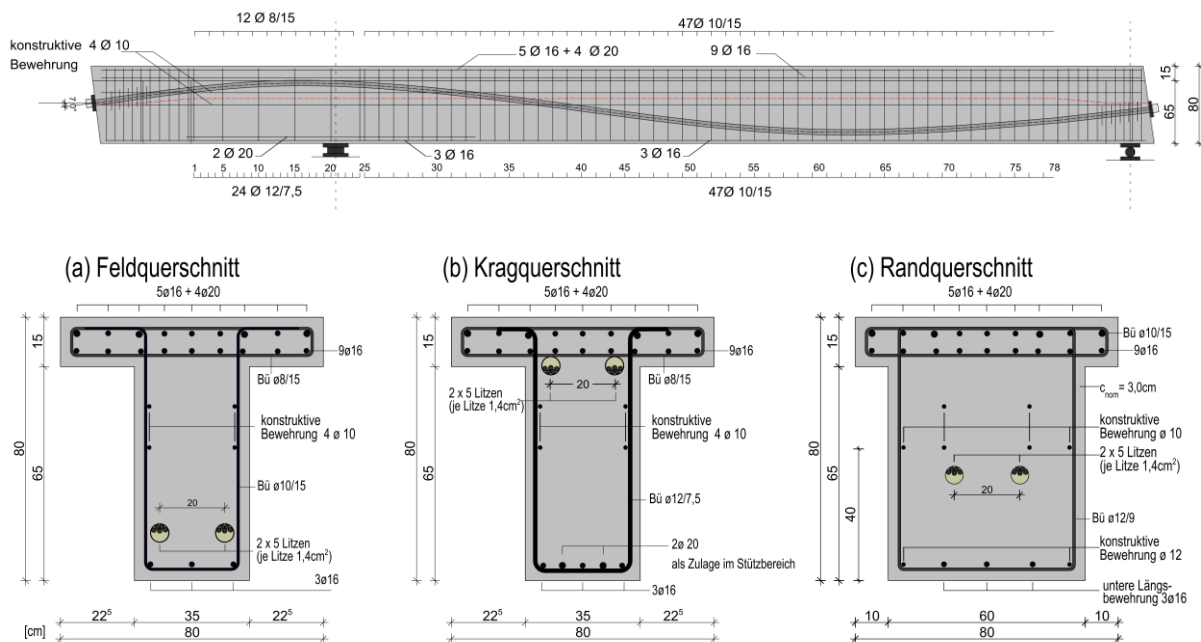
Bewehrungsplan Versuchsträger ETK4
